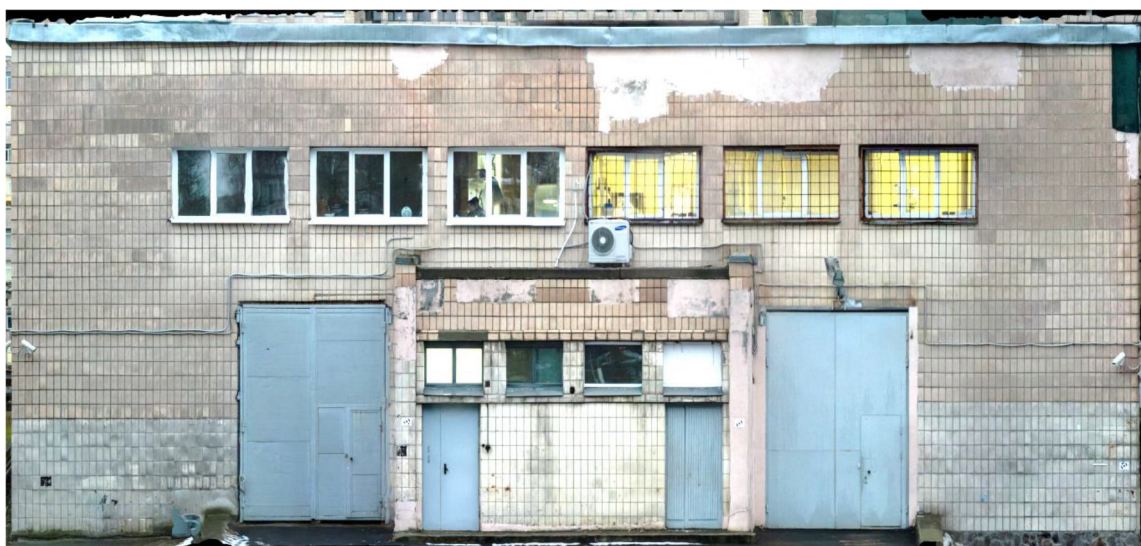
Ортофотоплан фасаду виробничої будівлі
